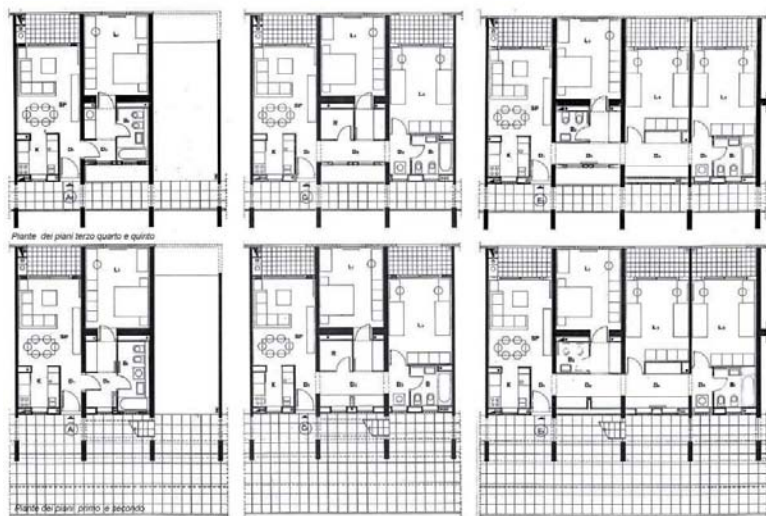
Pianta piano tipo degli alloggi dell'edilizia alta di Pazzigno
